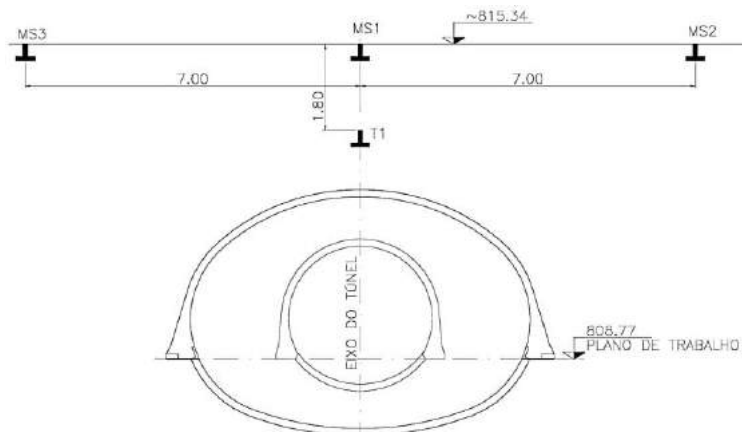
Seção típica da instrumentação externa instalada. Fonte: Projeto Executivo.
